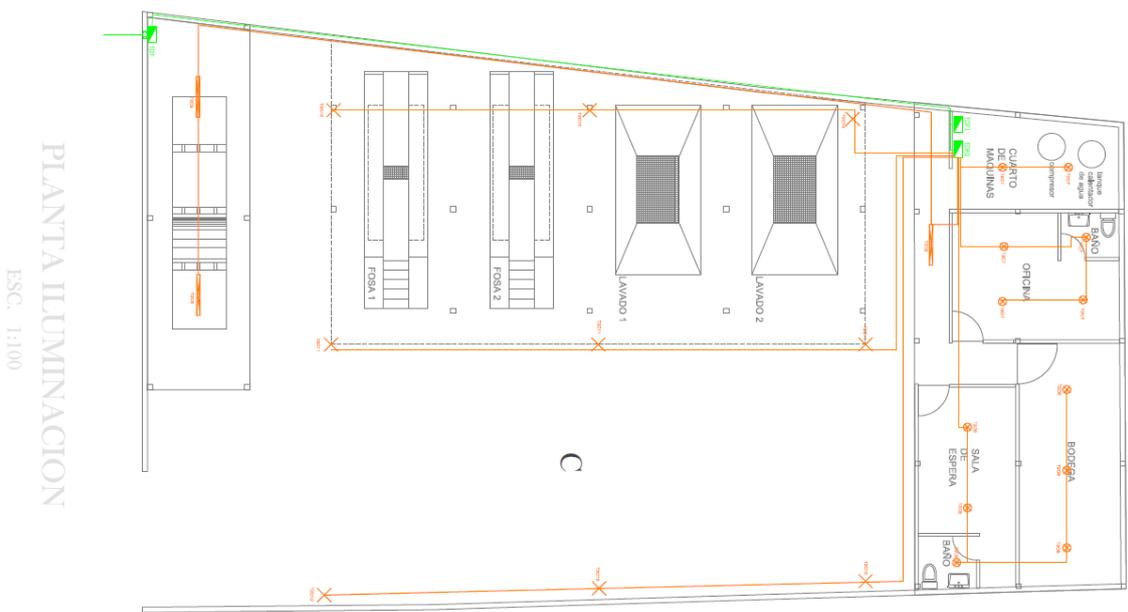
Plano de planta de iluminación, distribución de la iluminación del centro de auto lavado.
